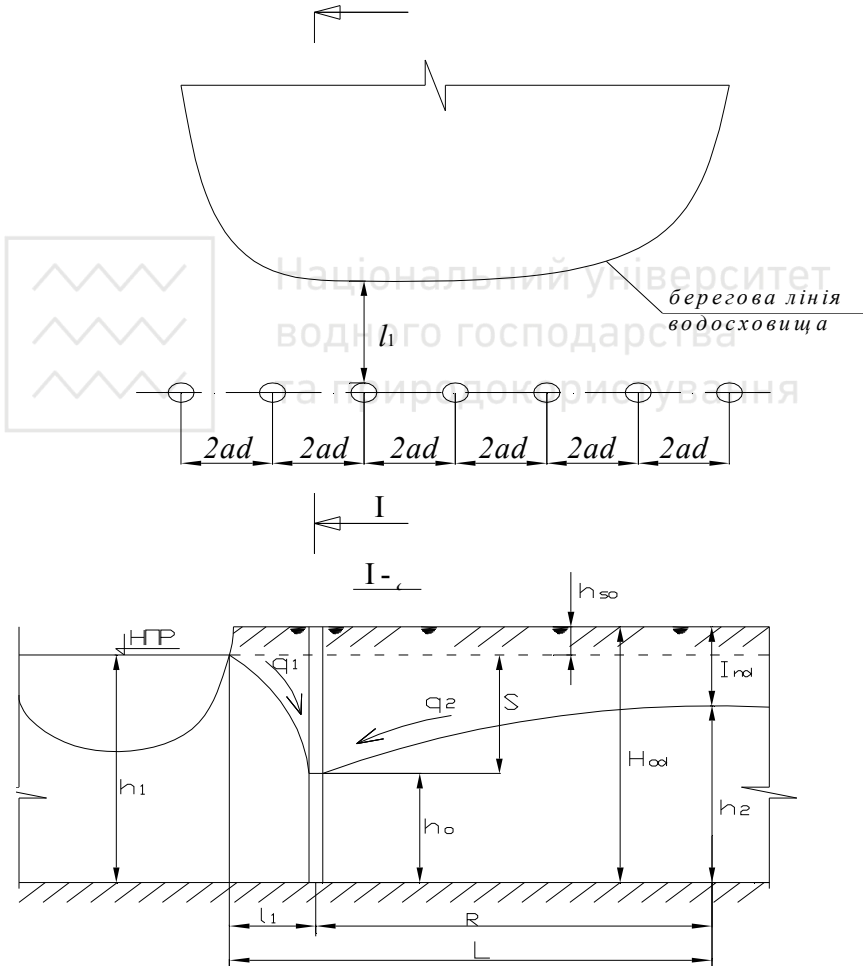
Розрахункова схема берегового вертикального дренажу
